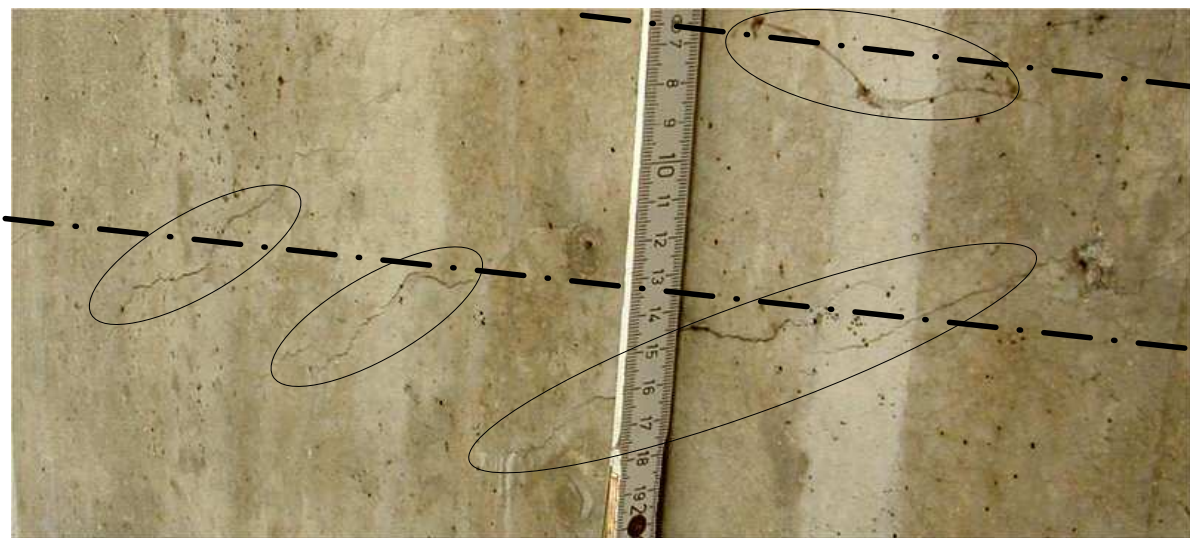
Etat du béton : fissuration de l'âme le long des câbles de précontrainte
